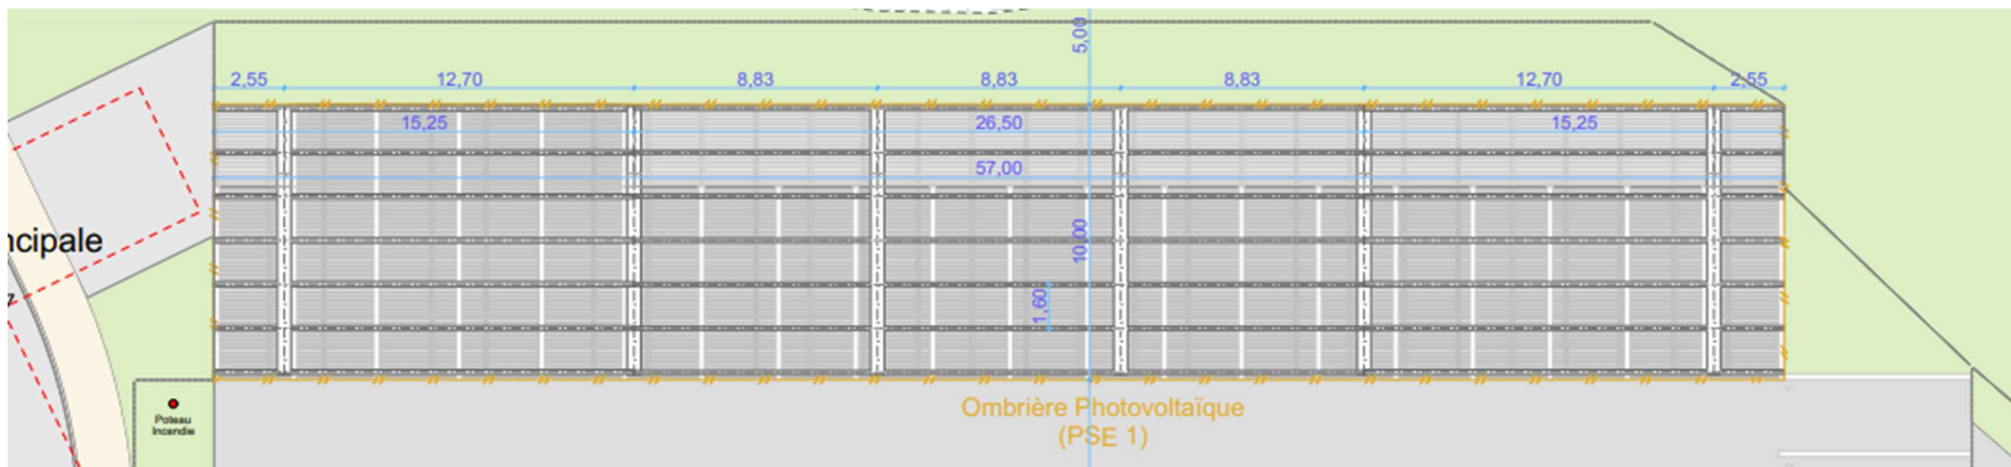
Plan de masse toiture Ombrière Poids Lourds
